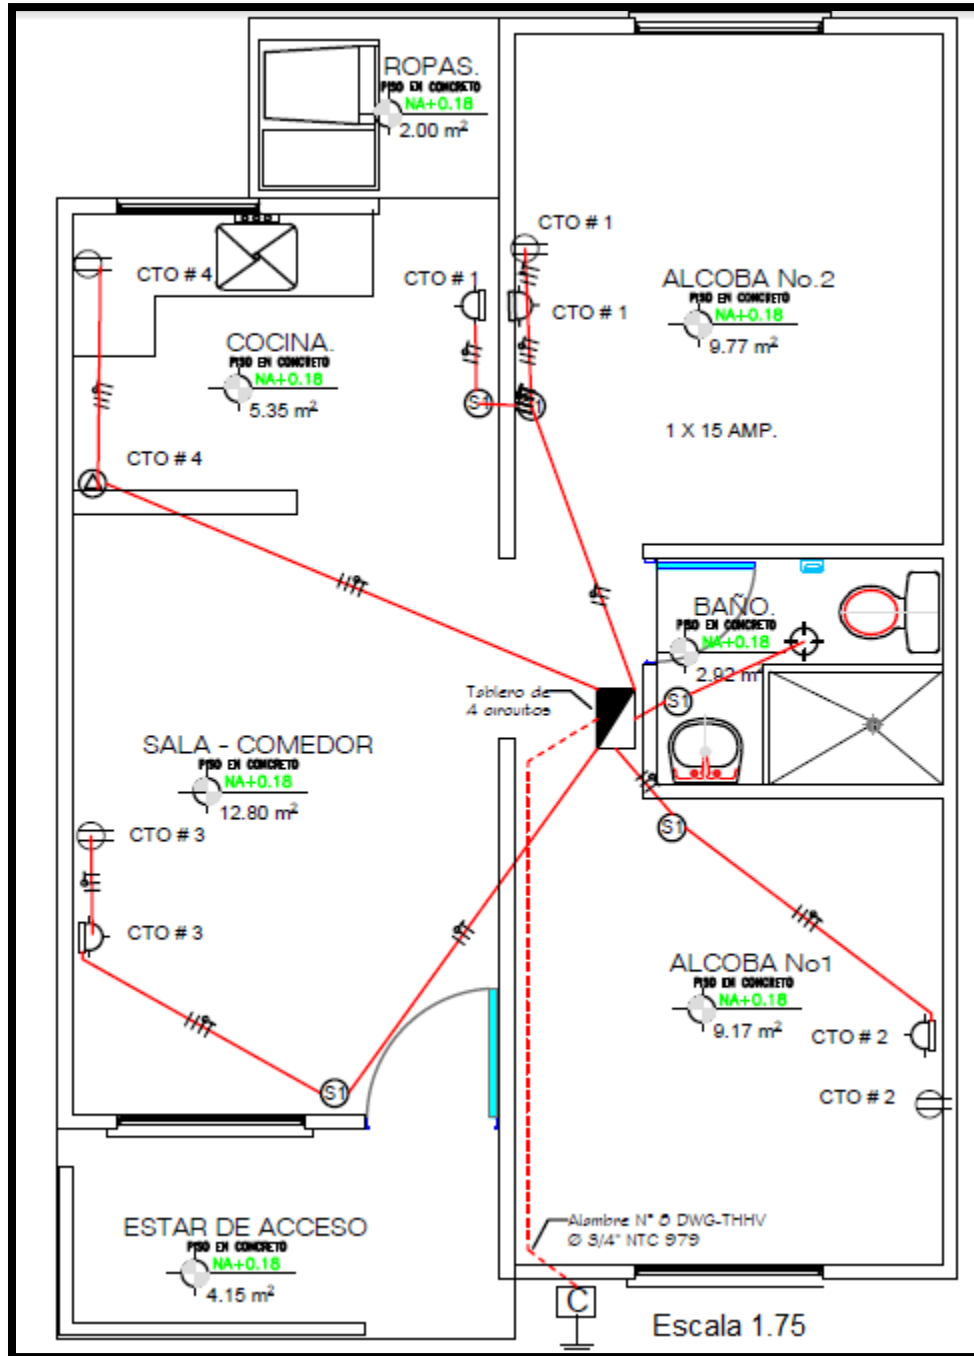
Planta Instalaciones Eléctrico Un Techo Para Todos CIU (CIU, 2016)
